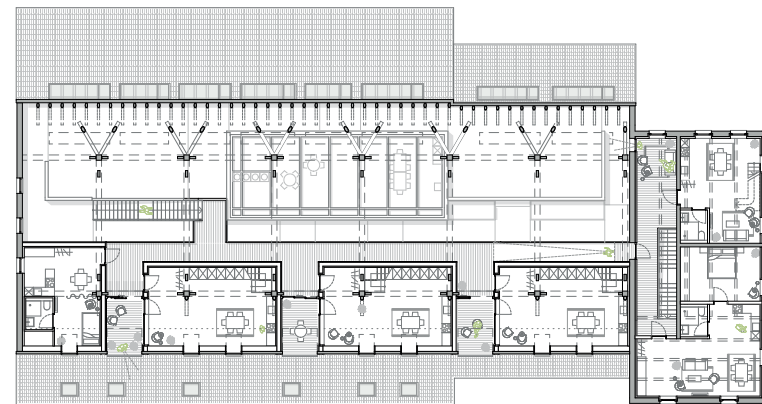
Grundriss 1. Obergeschoss M 1.500
